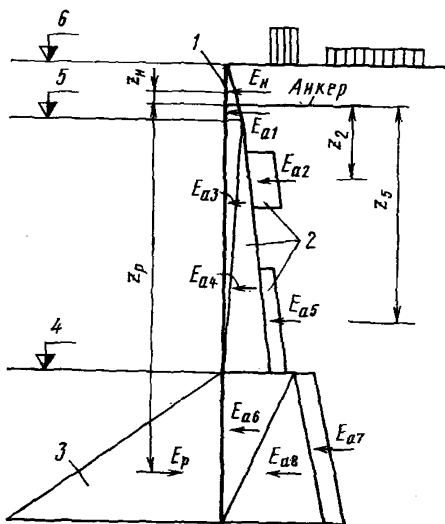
Схема расчета устойчивости лицевой стенки бьеверка на поворот вокруг точки крепления анкера;
